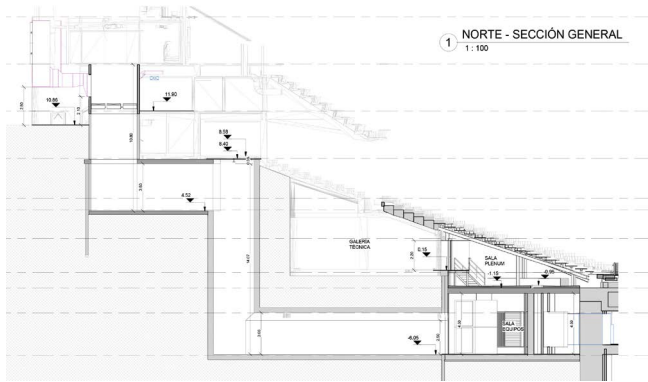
Sección de galería y paso inferior de las ventilaciones desde la sala de hipogeo. Imagen procedente proyecto de ejecución.
